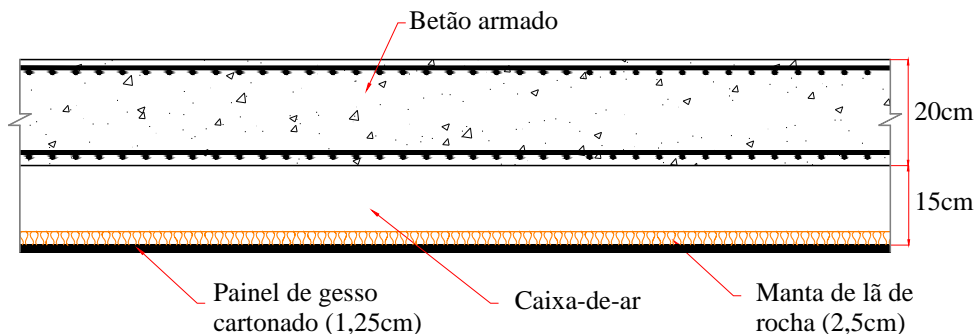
Pavimento de estrutura contínua em laje maciça de betão armado com tecto falso e isolante no tardoz (Pav5)
